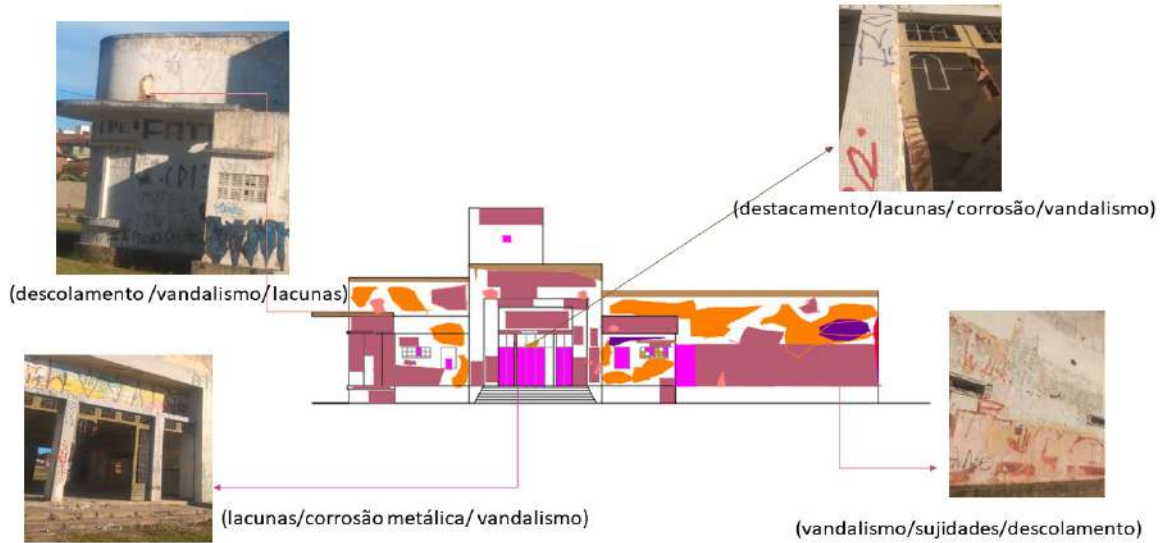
Fachada leste Fonte: acervo próprio (2021)
